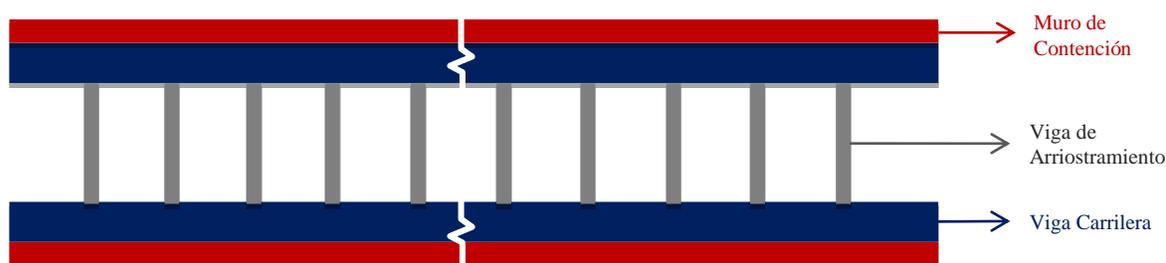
Esquema de vista de planta de muros de contención, vigas de arriostamiento y vigas carrileras de Apilador/Recuperador
